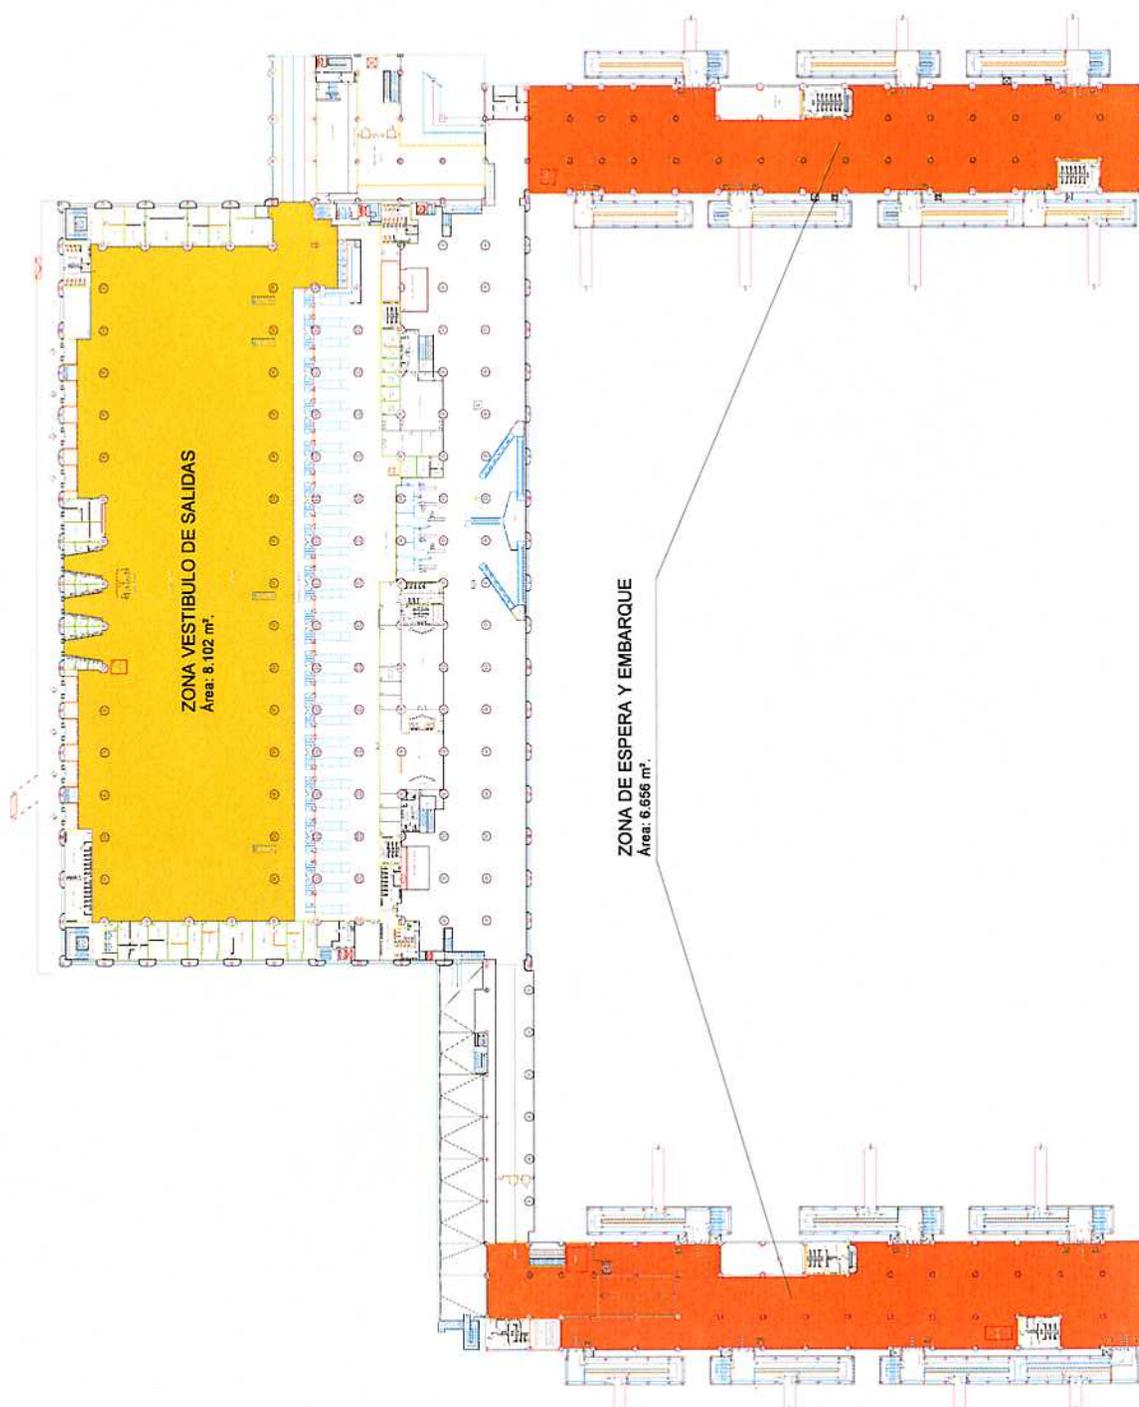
Instalaciones actuales. Planta baja T2
